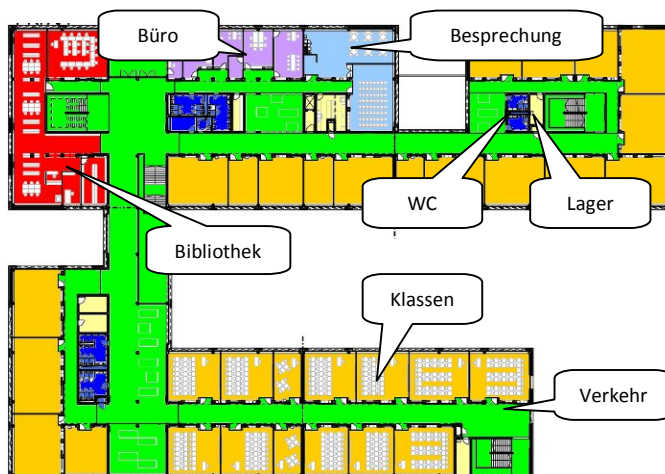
Grundriss Regelgeschoss mit Zonierung, Geb.8
